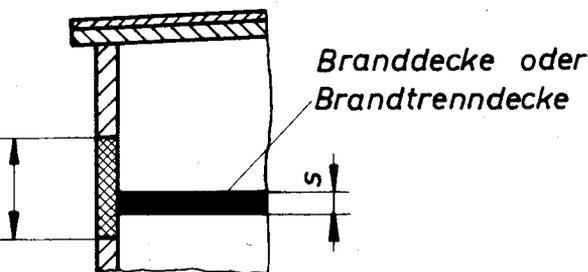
Anschluß einer Branddecke oder Brandtrenndecke an Außenwand
